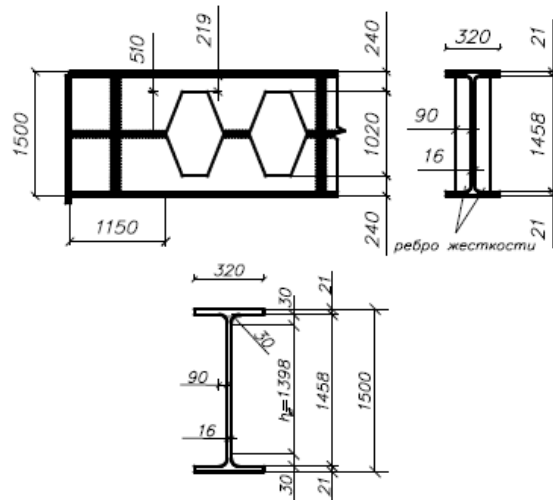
Схема подкрановой балки и крановой нагрузки
